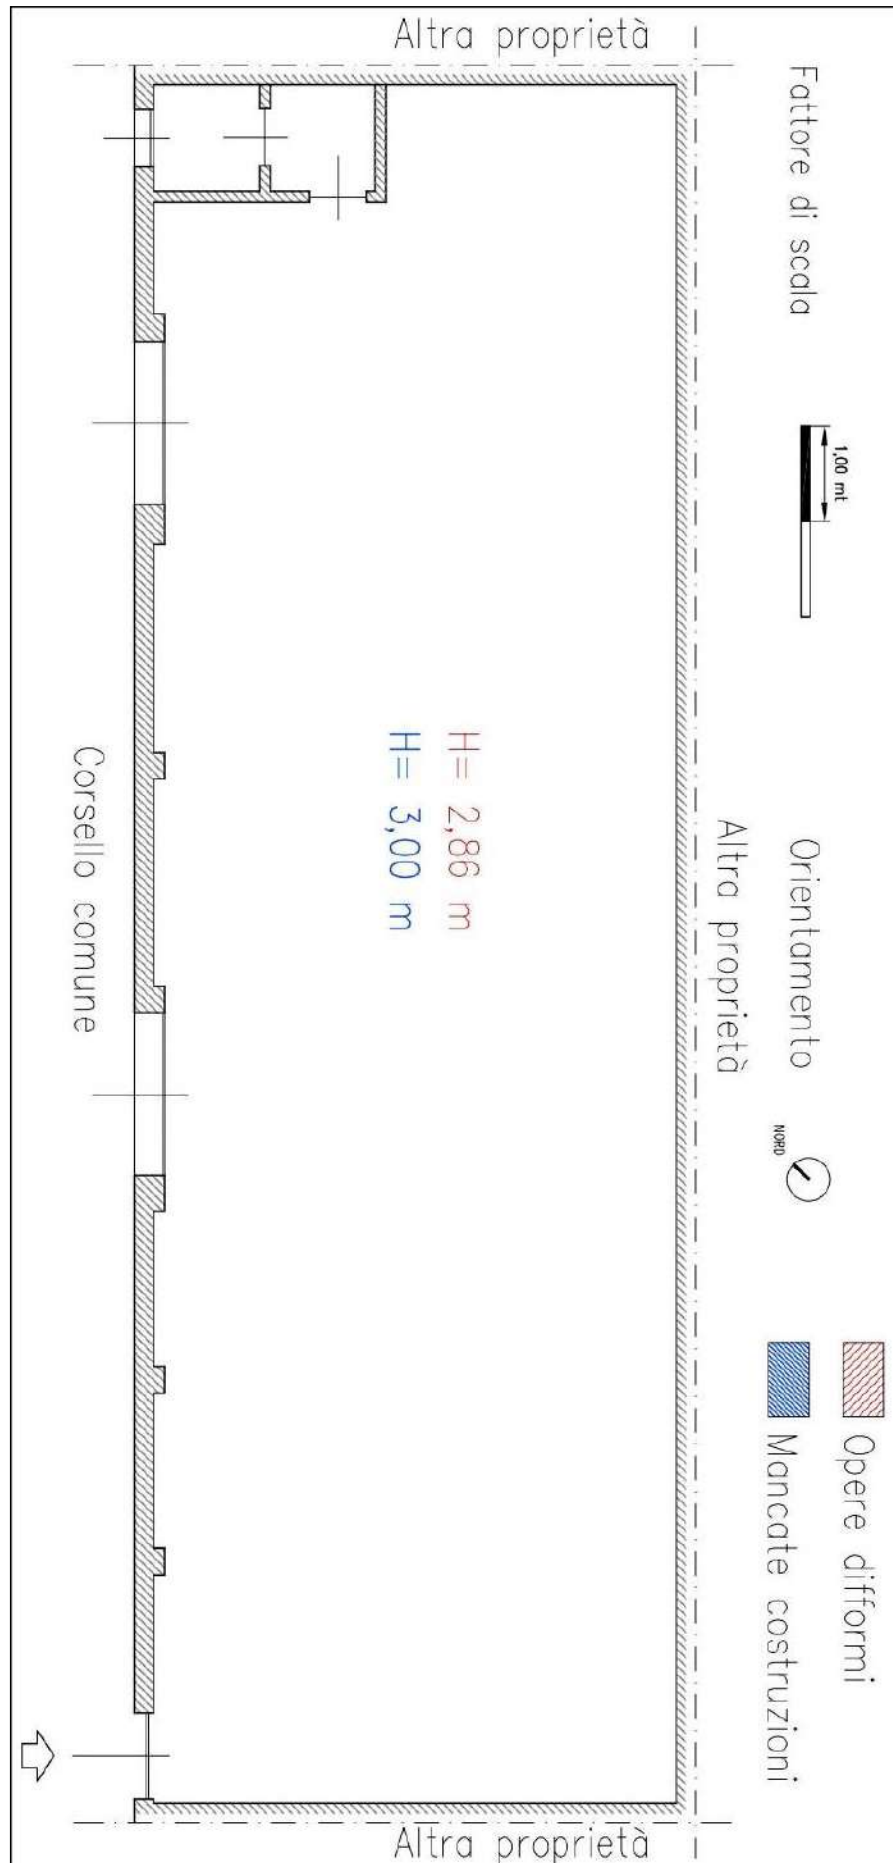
Confronto tra planimetria catastale e rilievo – Sez. SNA fg. 6 Part. 4333 sub 16
